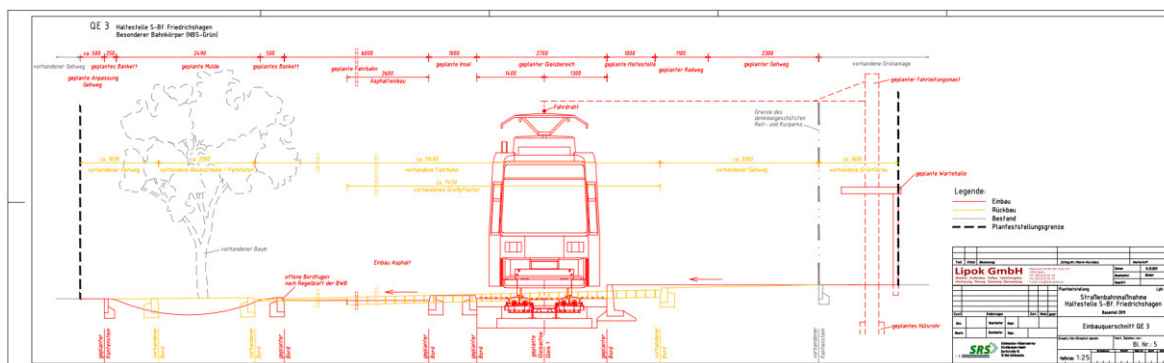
Einbauquerschnitt Haltestelle S-Bf. Friedrichshagen, Besonderer Bahnkörper (NBS-Grün) (Anlage 04)
